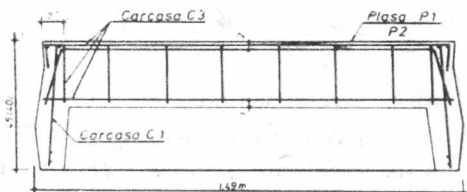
c. Armare cheson. Secțiuni transversale (proiect I.P.C.T.).
